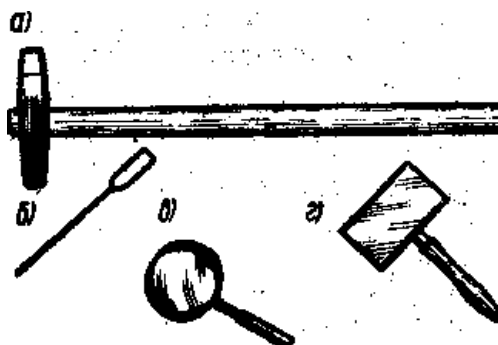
Ручной инструмент для проверки рельсов:
